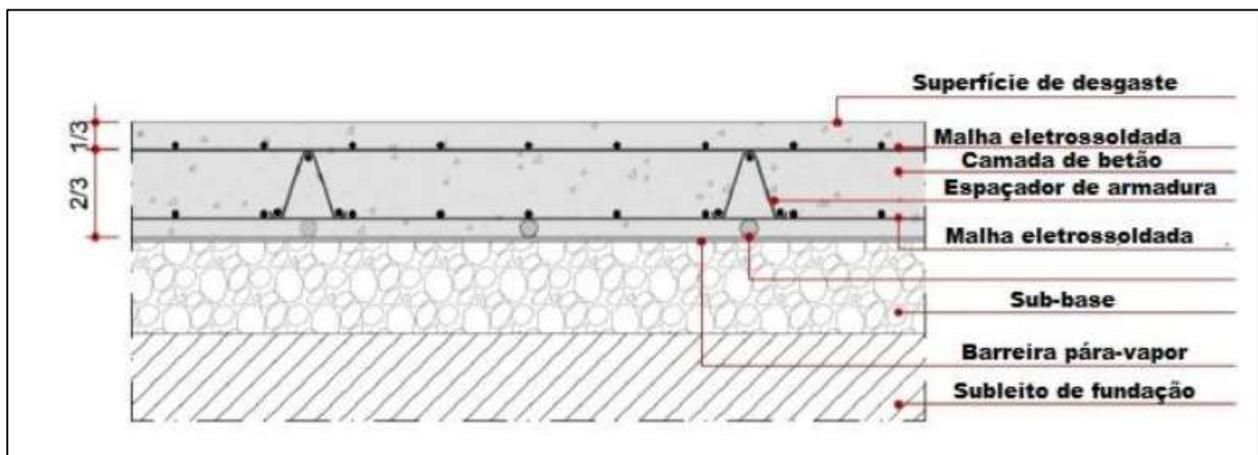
Perfil de pavimentos de betão armado (malha dupla).
